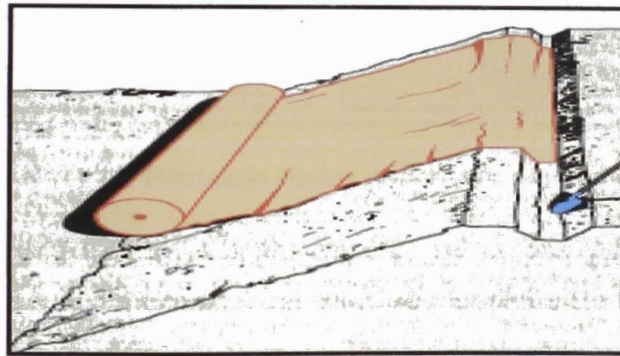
Colocación de geotextil. Fuente Analex.
